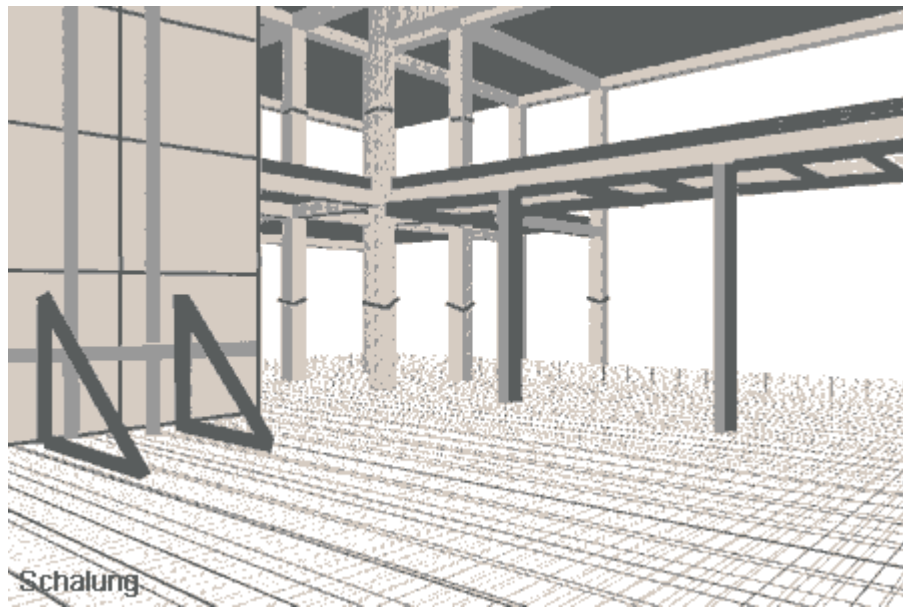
Schalung der Stahlbetonbauteile (Zeichnung)
